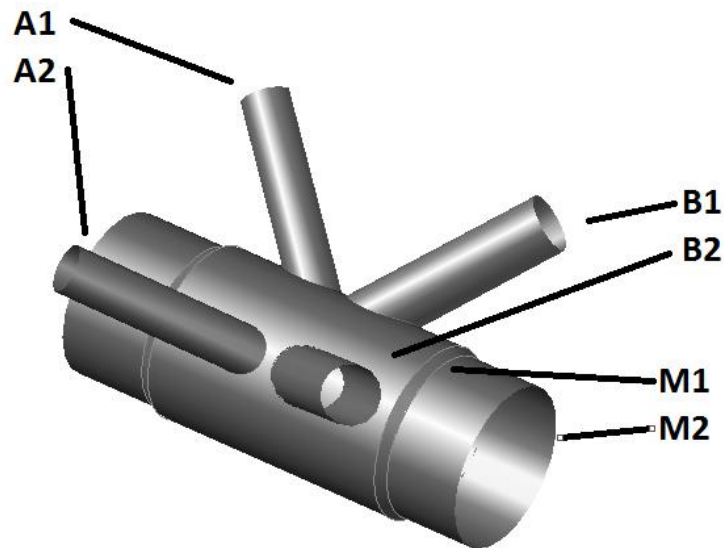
Dimensi tiga elevasi pada jacket dari atas
